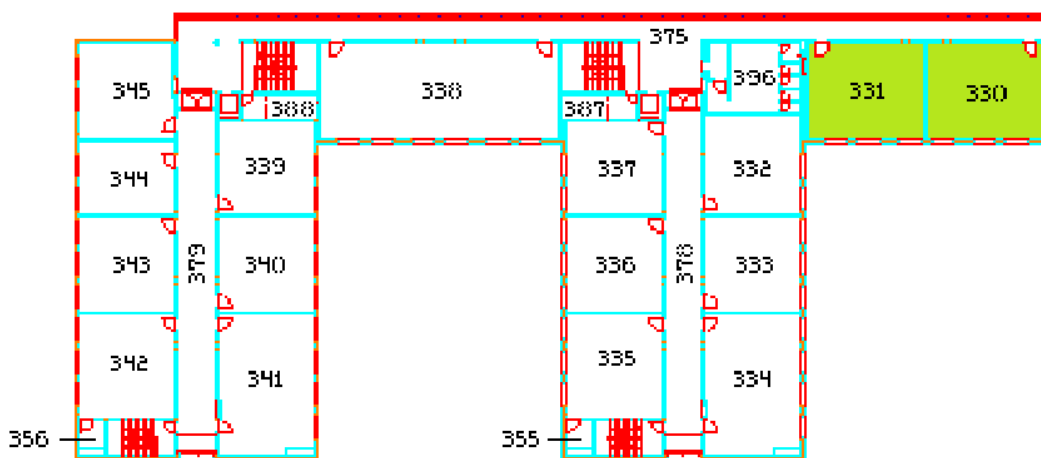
Planta das salas ensaiadas *in situ* [37].
